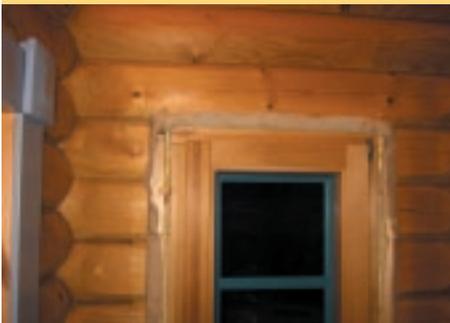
Eingebauter Fensterdübel mit darüberliegendem Setzungsraum.
